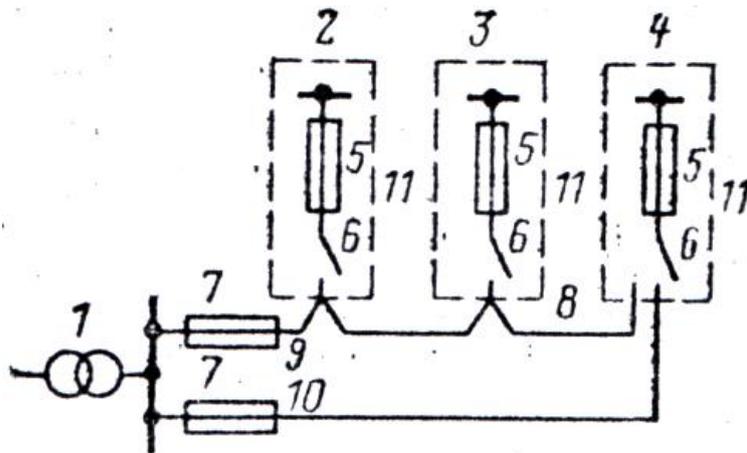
Схема питания жилых домов высотой до 5 этажей с резервной перемычкой:
